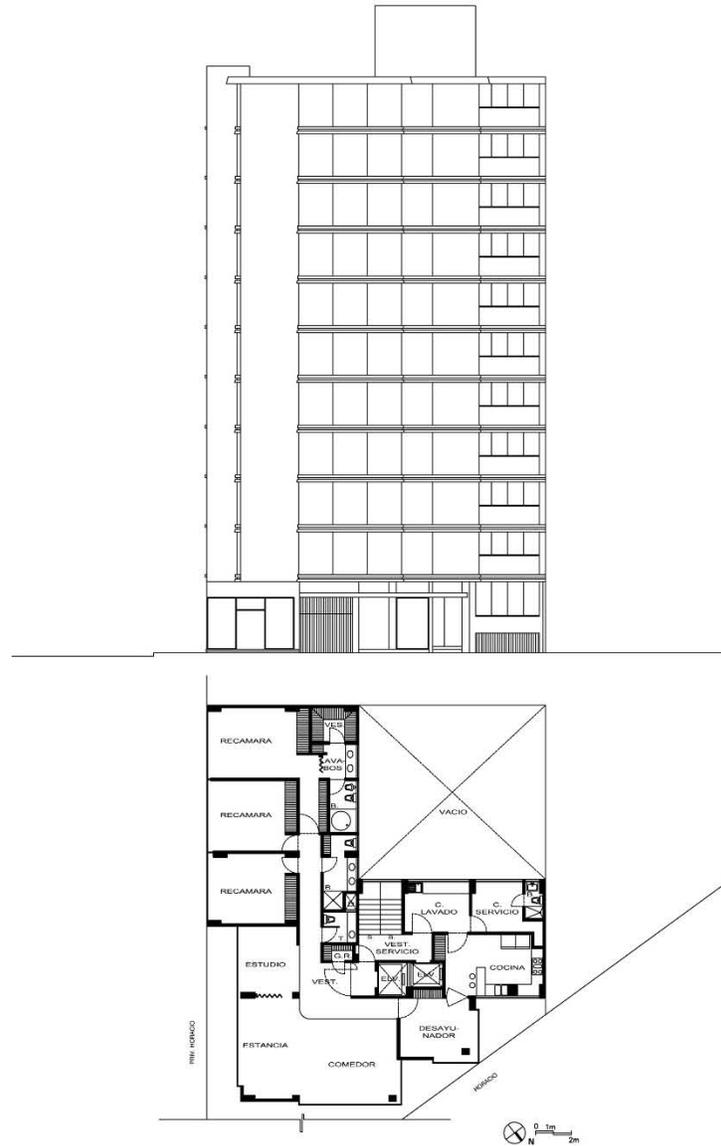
Fachada y planta del edificio ubicado en Horacio núm. 1834
